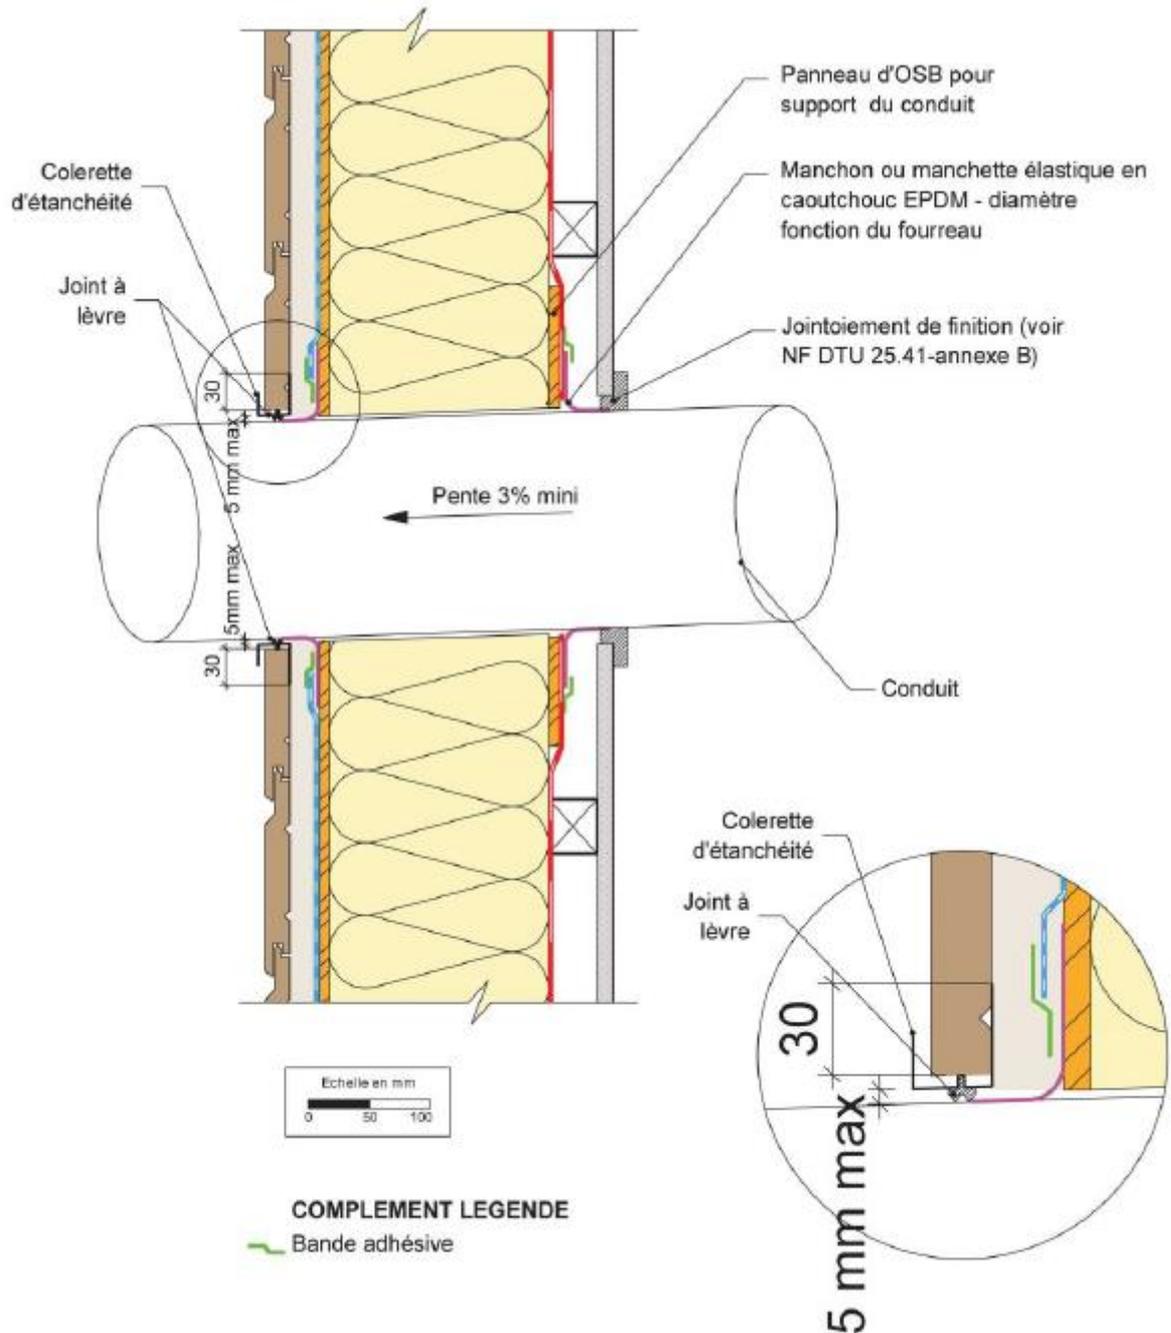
Raccordement de l'étanchéité à l'air et à l'eau en périphérie d'un élément traversant par un manchon EPDM – niveau d'étanchéité Ee2 (coupe verticale)
